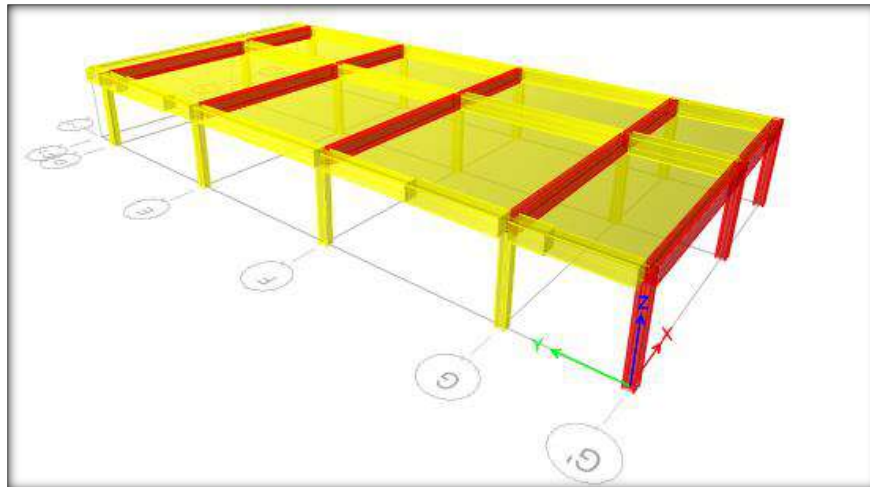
Elementos nuevos (columnas y vigas) reforzamiento Estructura 2.2 CENIGRAF
